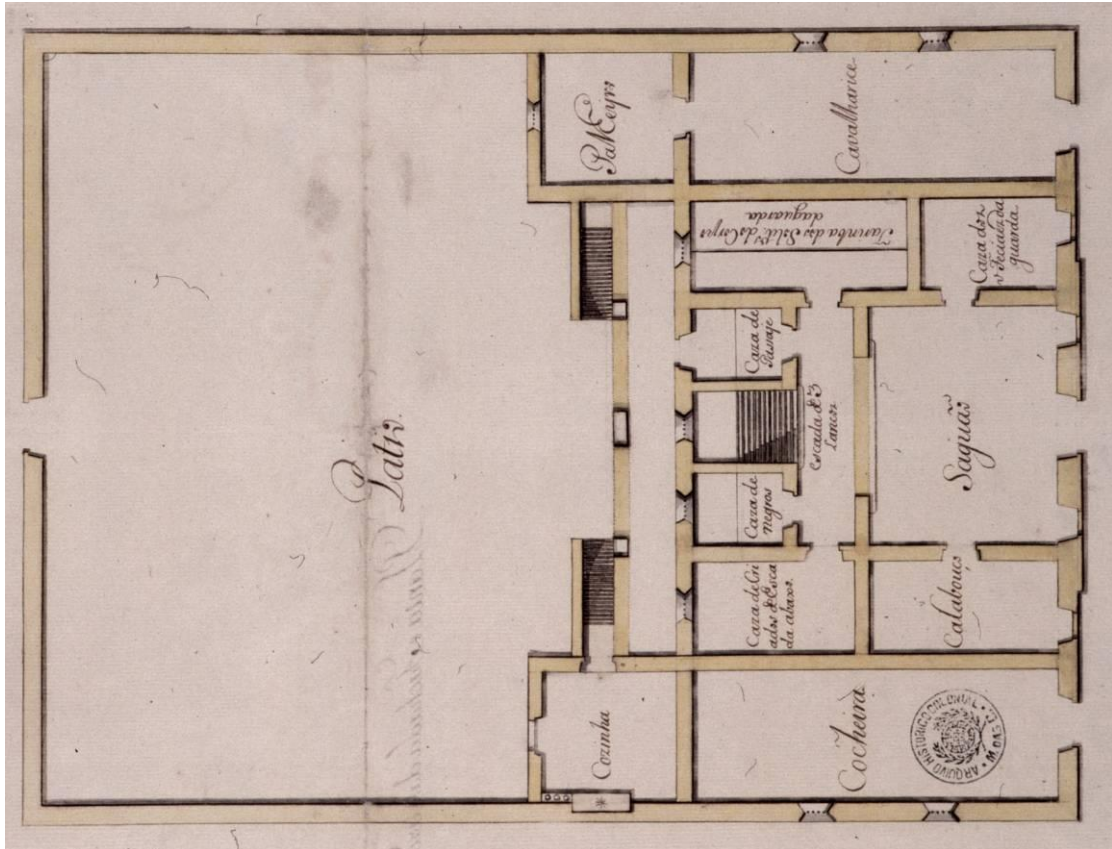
Planta baixa, pavimento térreo, do antigo Palácio dos governadores de Santa Catarina, construído na segunda metade do século XVIII.
